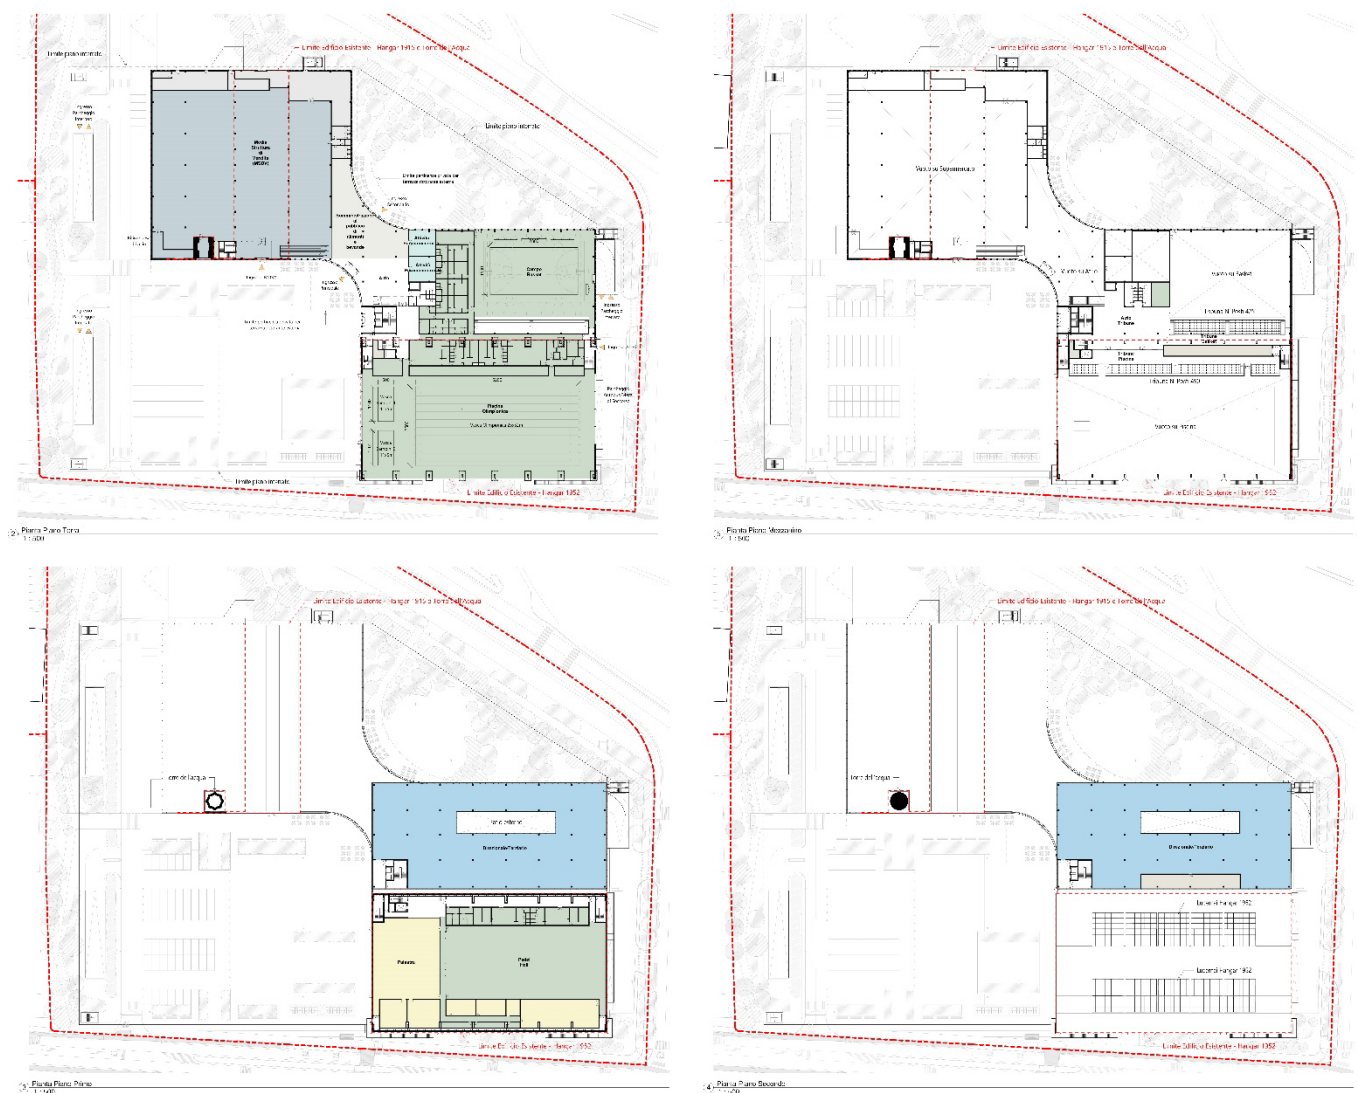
Stralcio Piante del Complesso Multifunzionale
